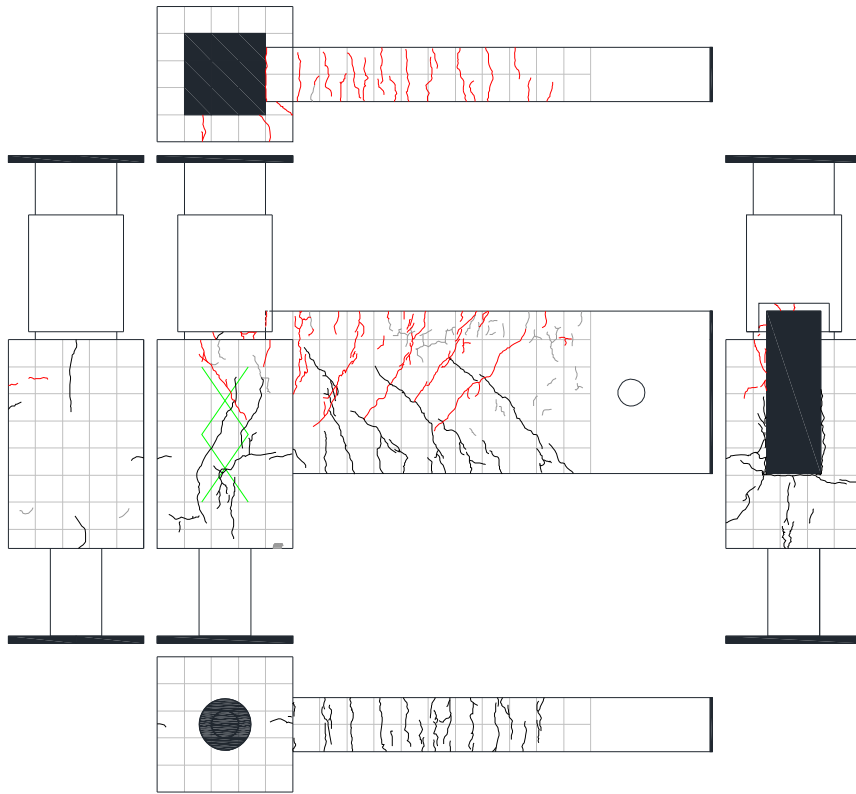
試験体 D-4 ひび割れ状況 (3Cycle)
